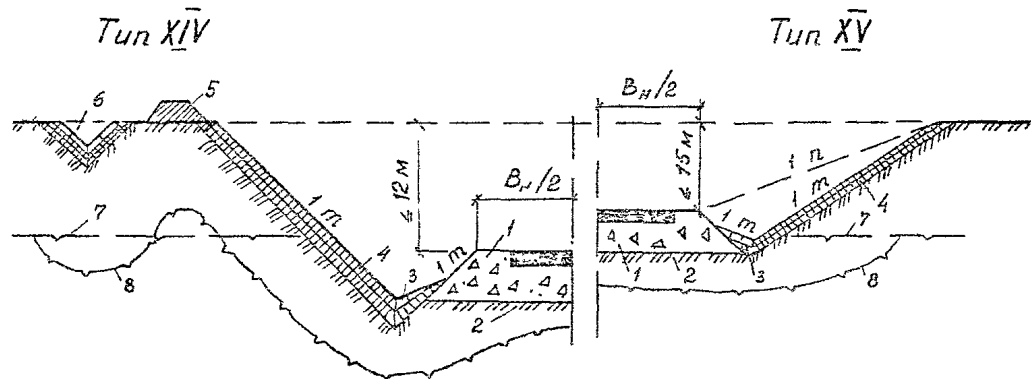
Поперечные профили в слабоподнасыщенных грунтах:
